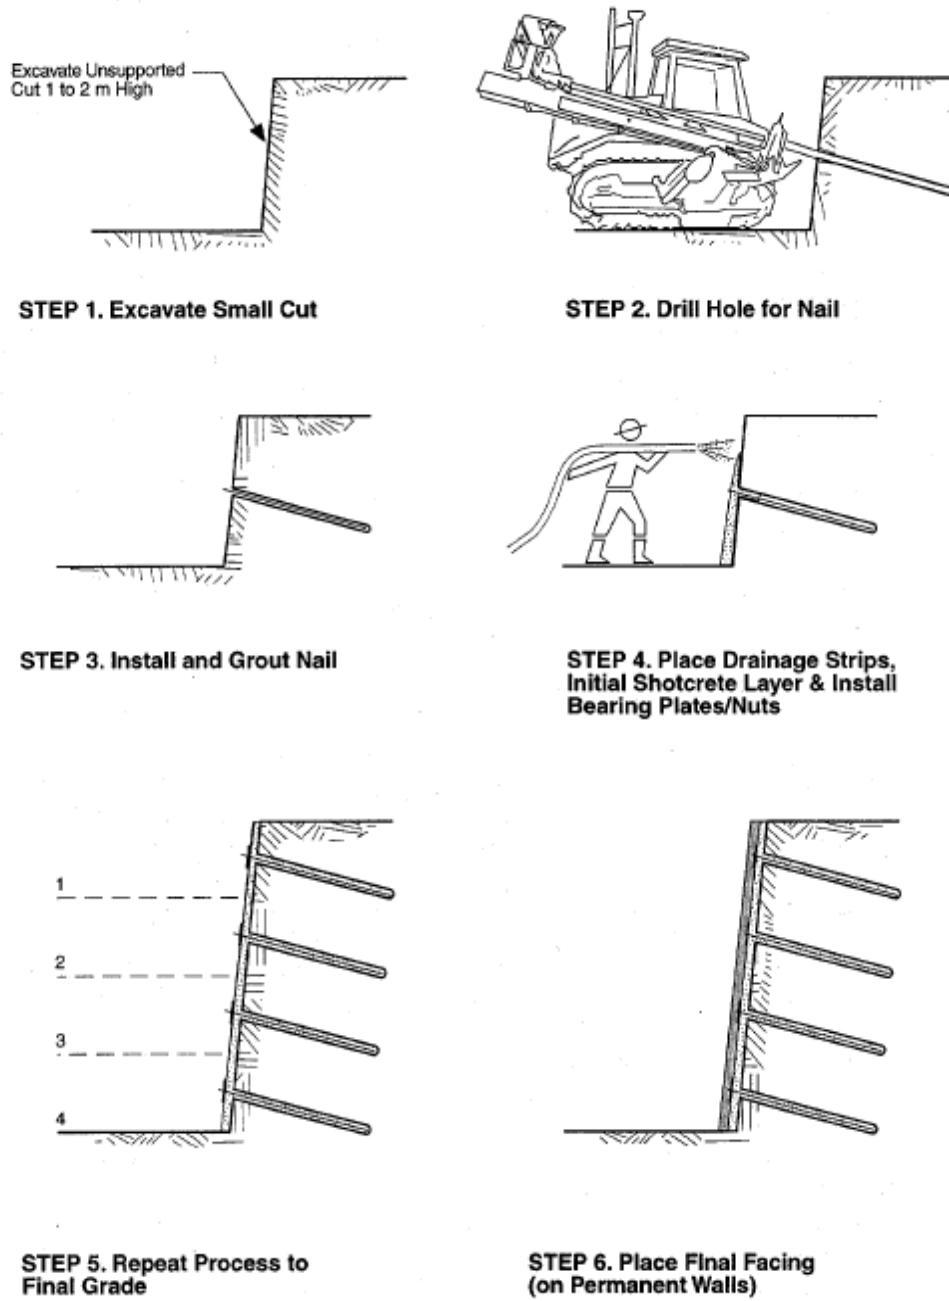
Paso a paso sistema constructivo. Fuente: Byrne, Cotton, Poterfield, Wolschlag, & Ueblcker (1998).
